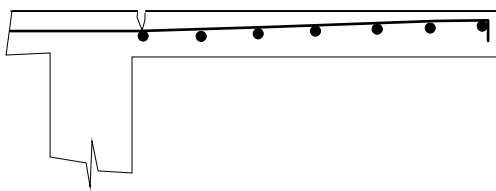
Posicionamento incorreto da armadura negativa de lajes em balanço
